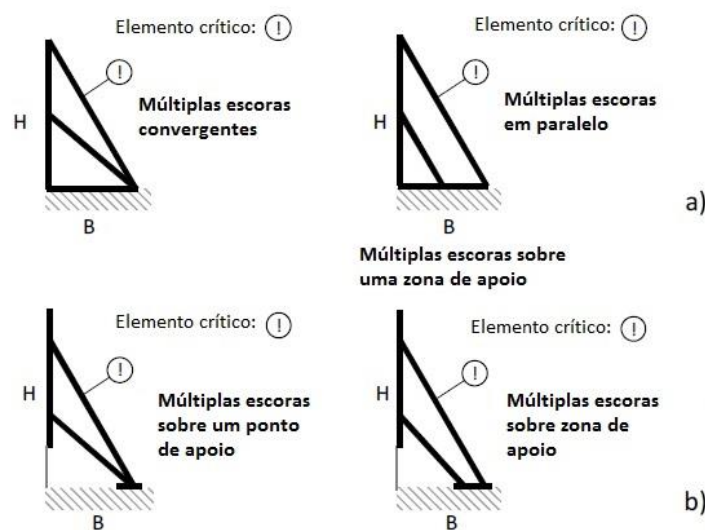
Determinação do elemento mais solicitado (elemento crítico). a) "sobre a base de apoio" e b) "sobre ponto de apoio".
